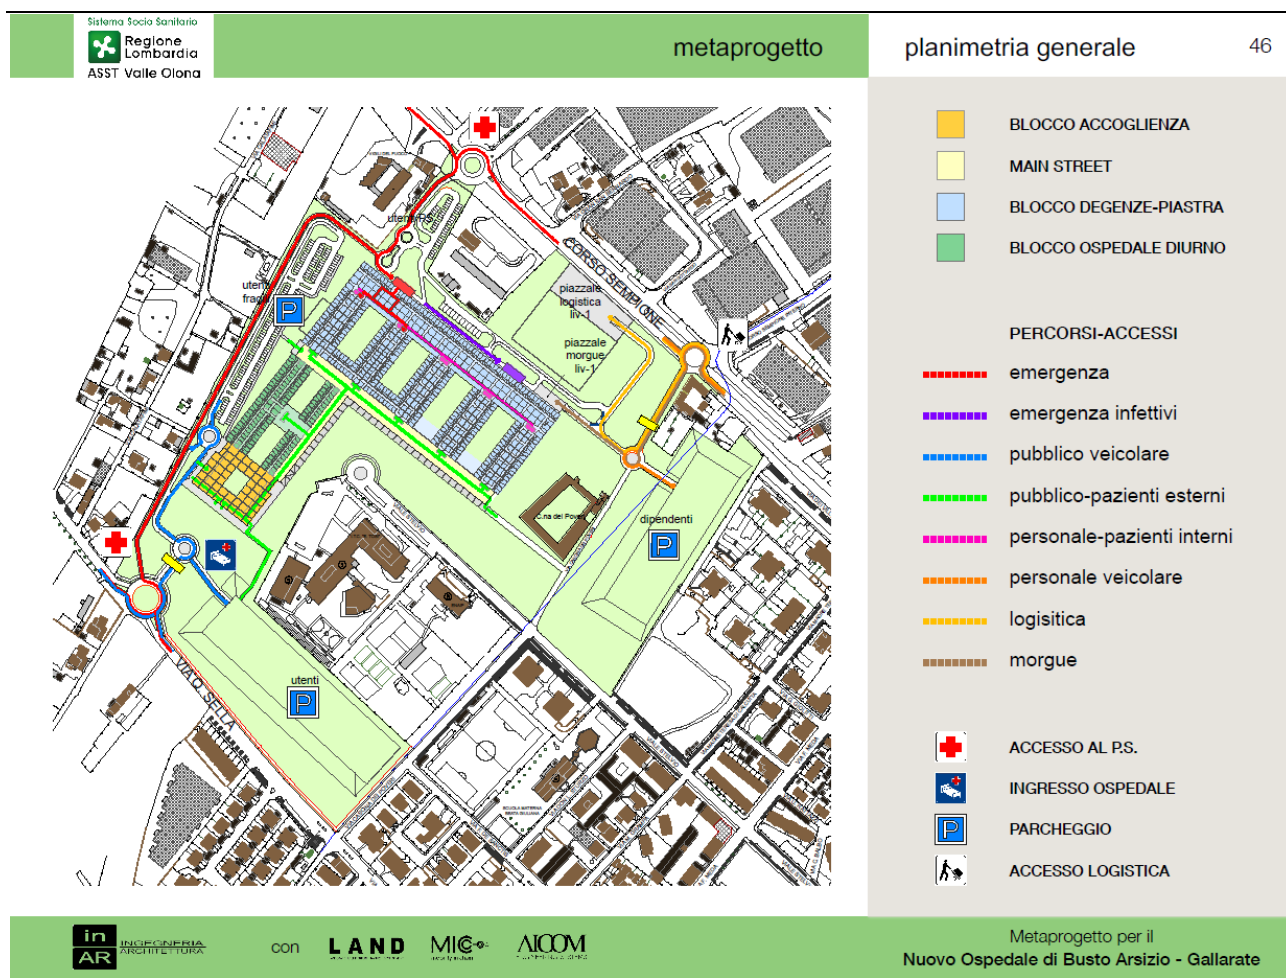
Metaprogetto: schema planimetrico con individuazione dei blocchi funzionali
